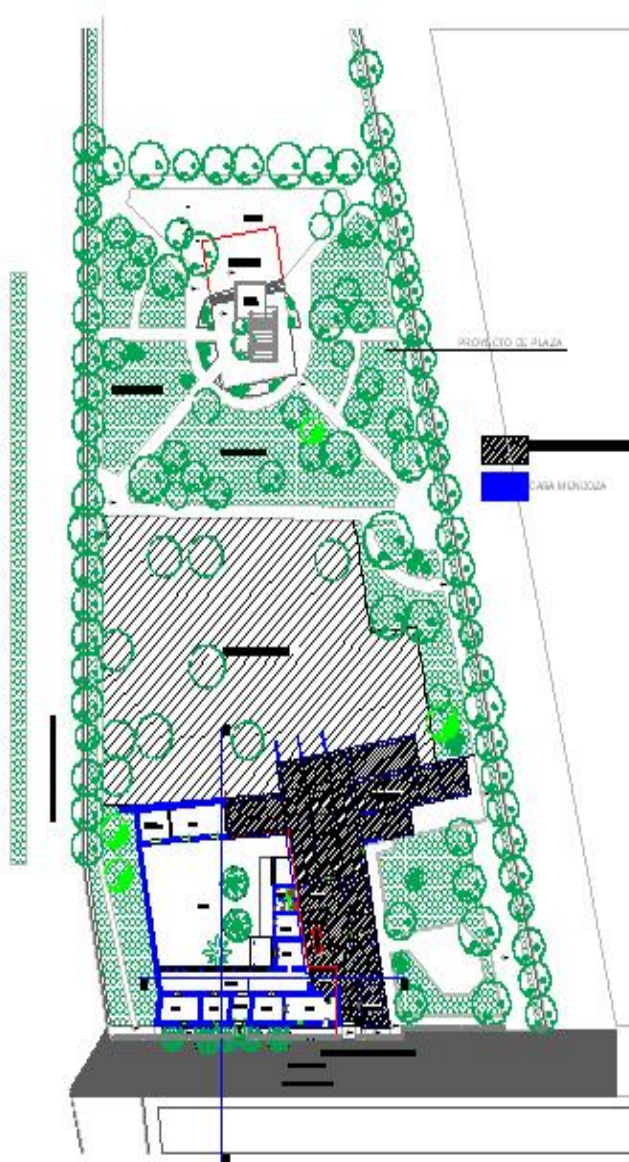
proyecto total restauración y reconstrucción de salones caídos de la casa, junto con la plaza y pavimento articulado
